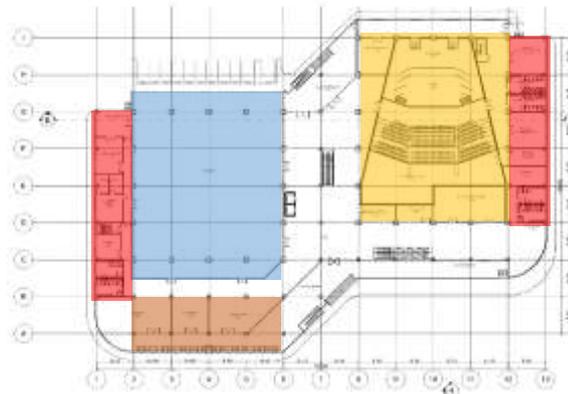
zoning tapak dan sirkulasi bangunan (Blok Plan)
